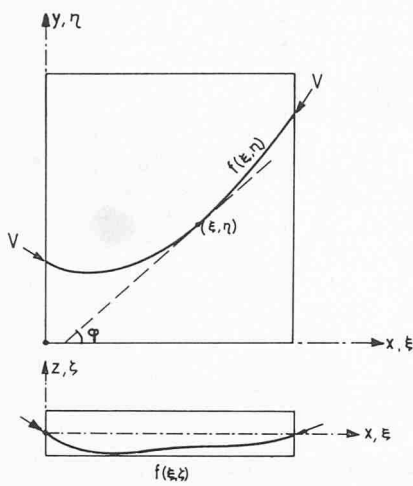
(links). Rechteckplatte mit Spannungsglied in allgemeiner Lage im Grundriss und im Aufriss
